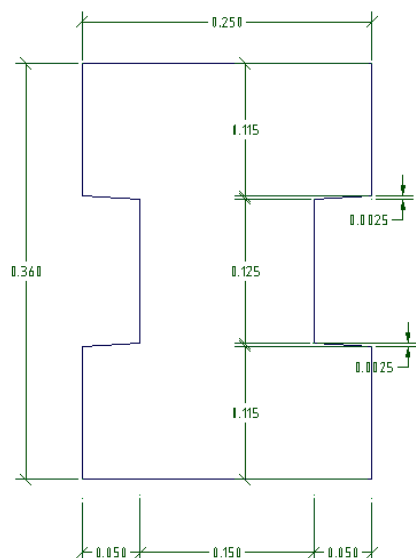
Secção admitida do Pilarete de suporte dos painéis
